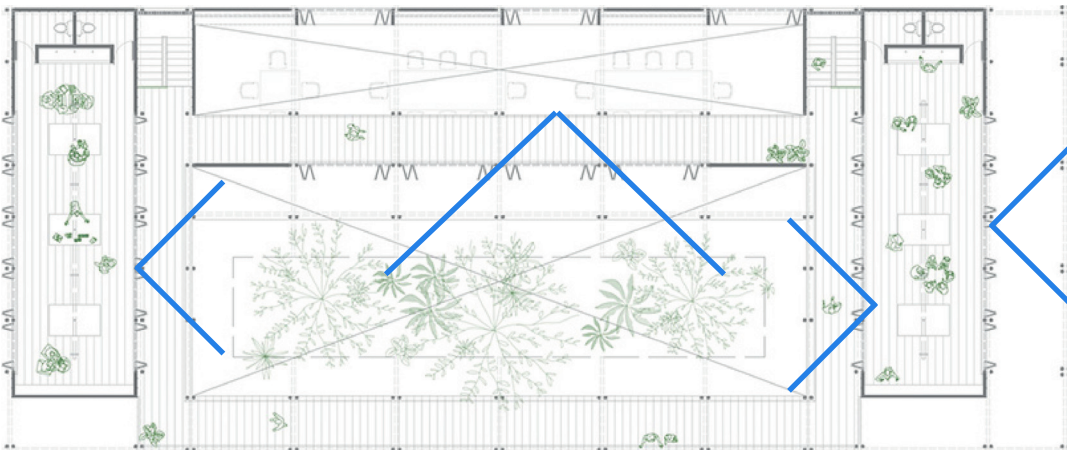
"Las Tejedoras" – Planta alta - Vistas
